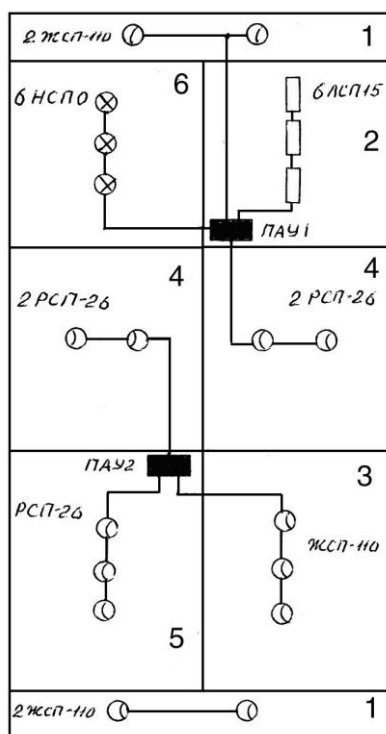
План экспериментальной СТУ доильного блока:
